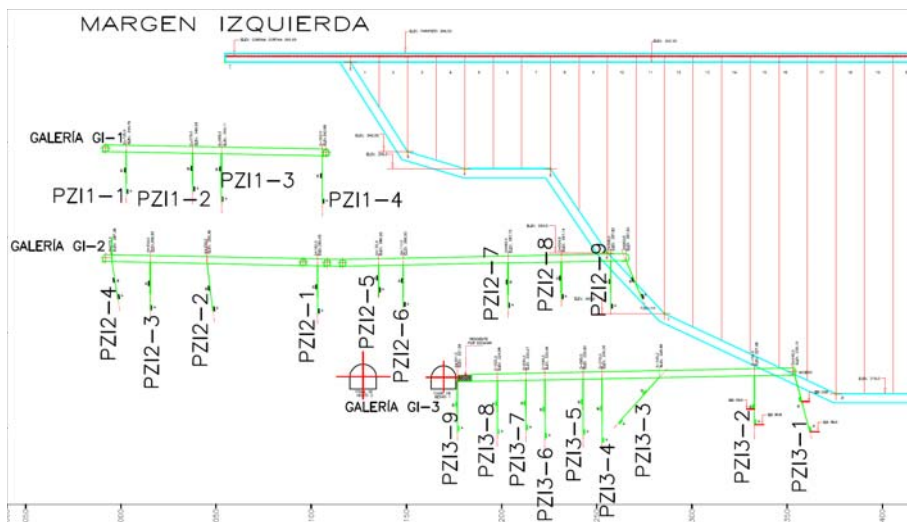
Piezómetros en las galerías de la margen izquierda.
